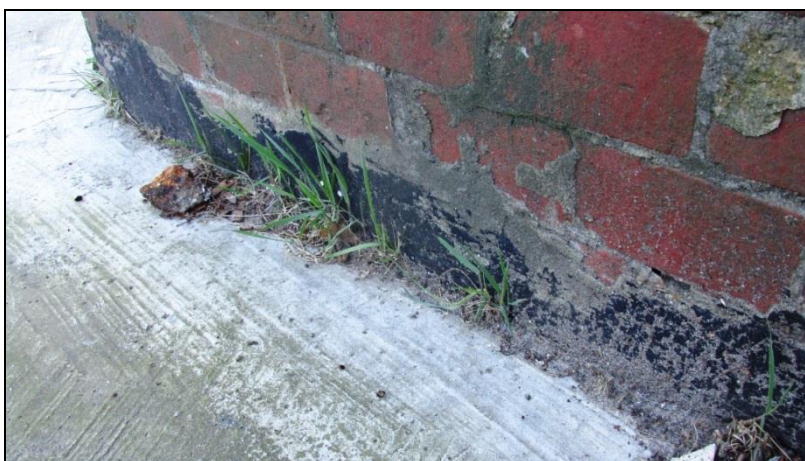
Roślinność drzewiasta rozwijająca się wzdłuż elewacji wschodniej budynku
